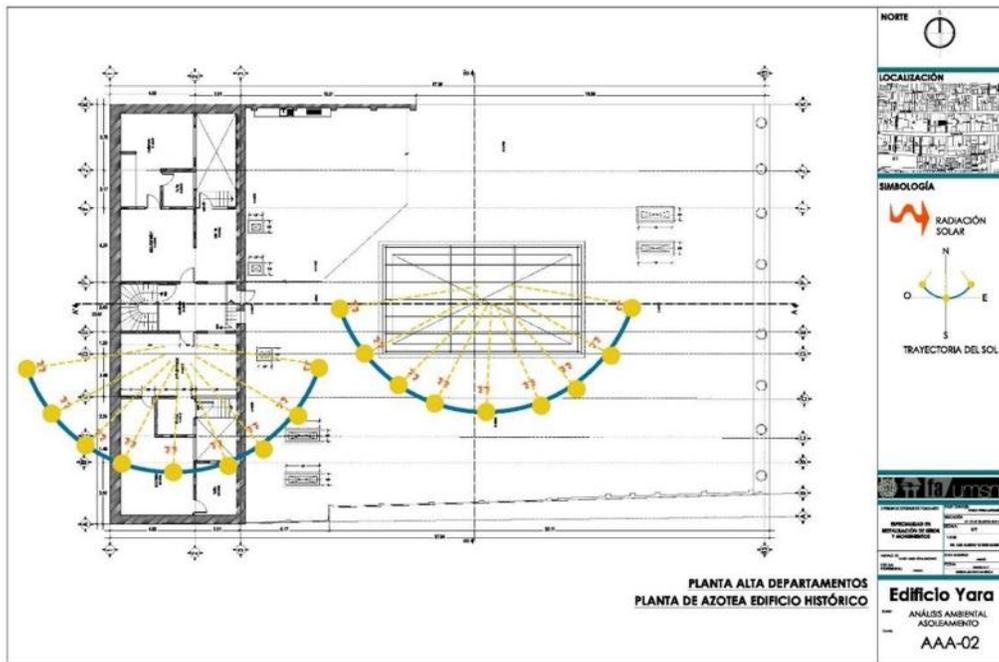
Esquema de asoleamiento en el inmueble. Planta alta departamentos.
